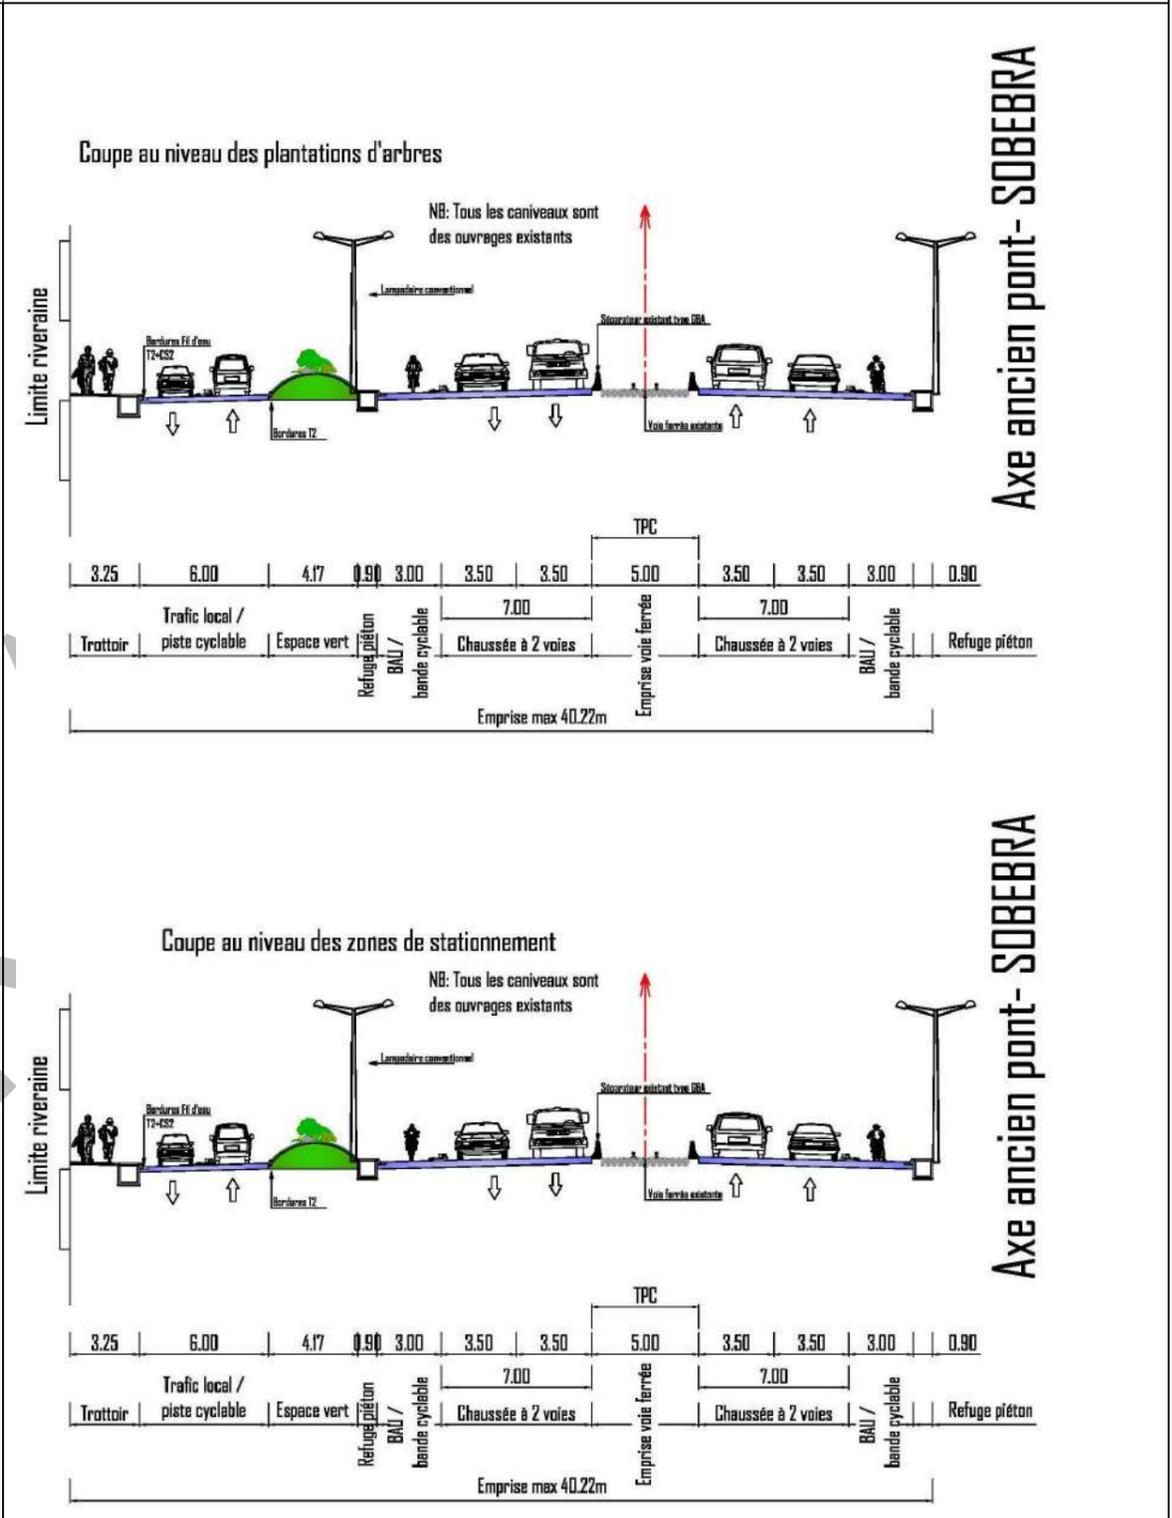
Profil en travers pour la section « Carrefour La roche- Carrefour SOBEBRA »
